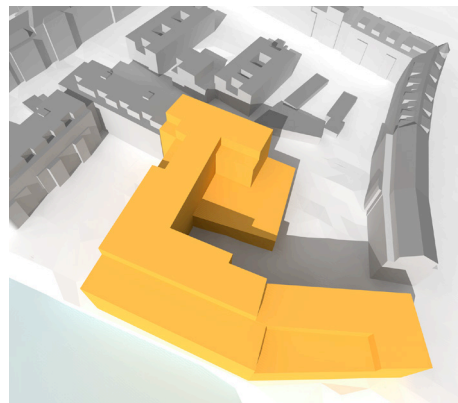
Maximale Bebauung nach gültigem Planrecht
